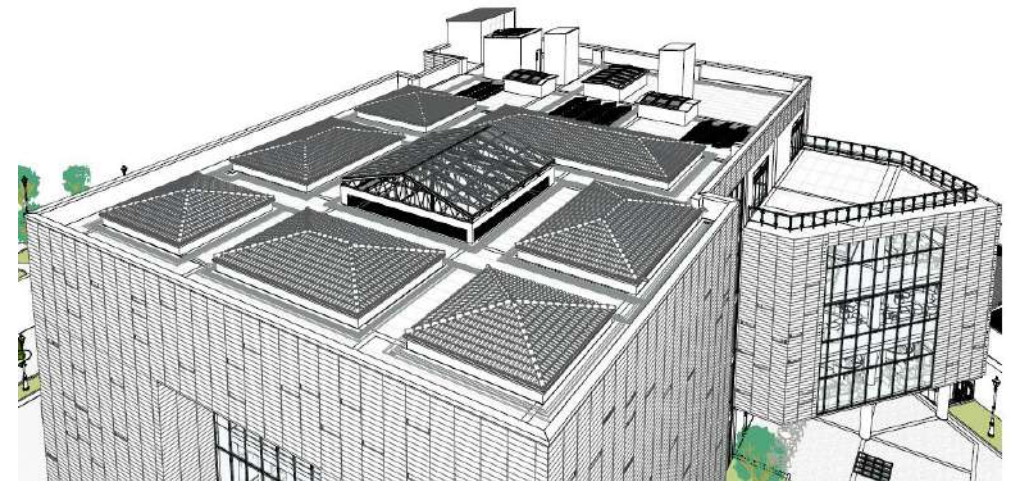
Sistema de Cubiertas – Bloque Biblioteca.
